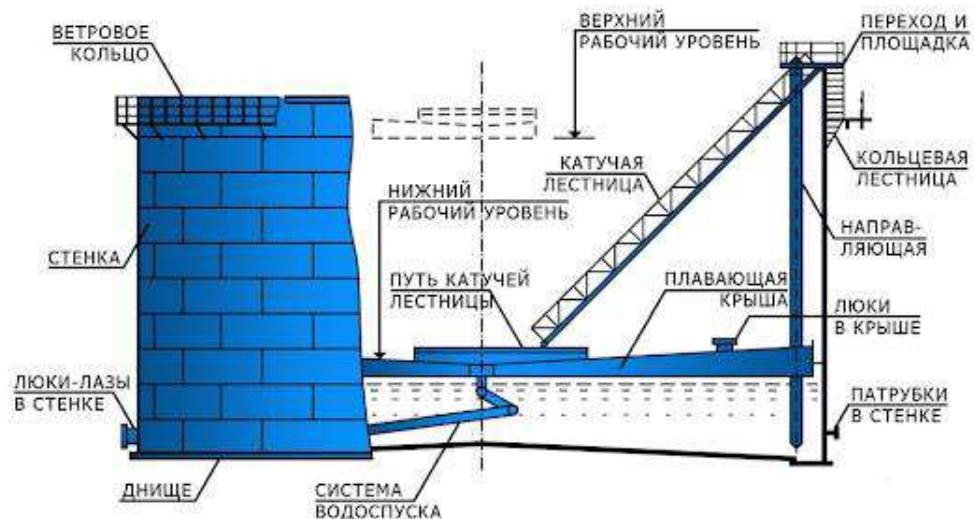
Вертикальный резервуар с плавающей крышей
